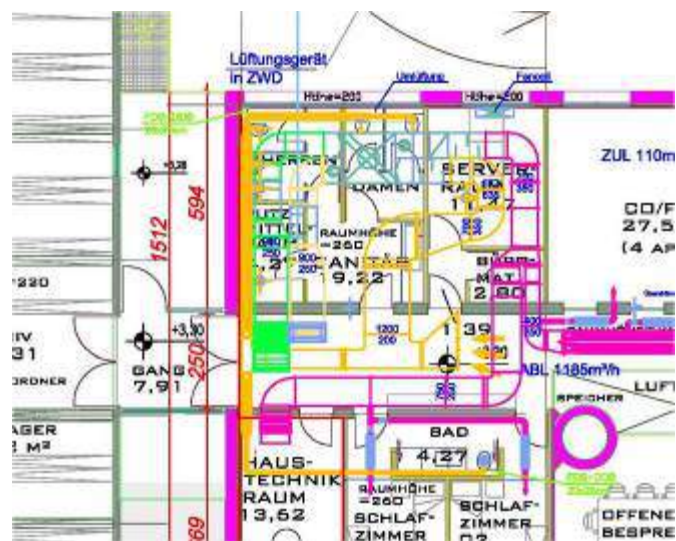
Ursprüngliche Positionierung (Grundriss OG)
